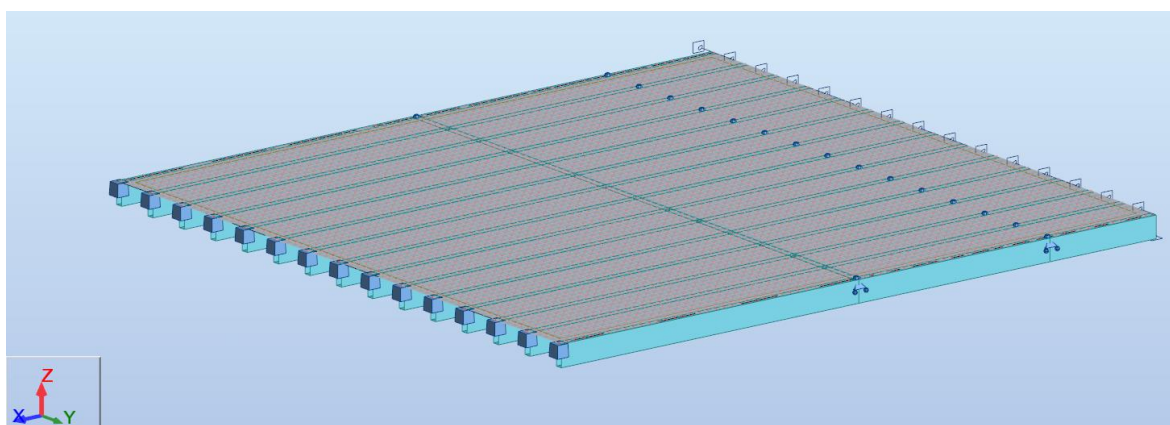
Modelo numérico do pavimento PVC_3
